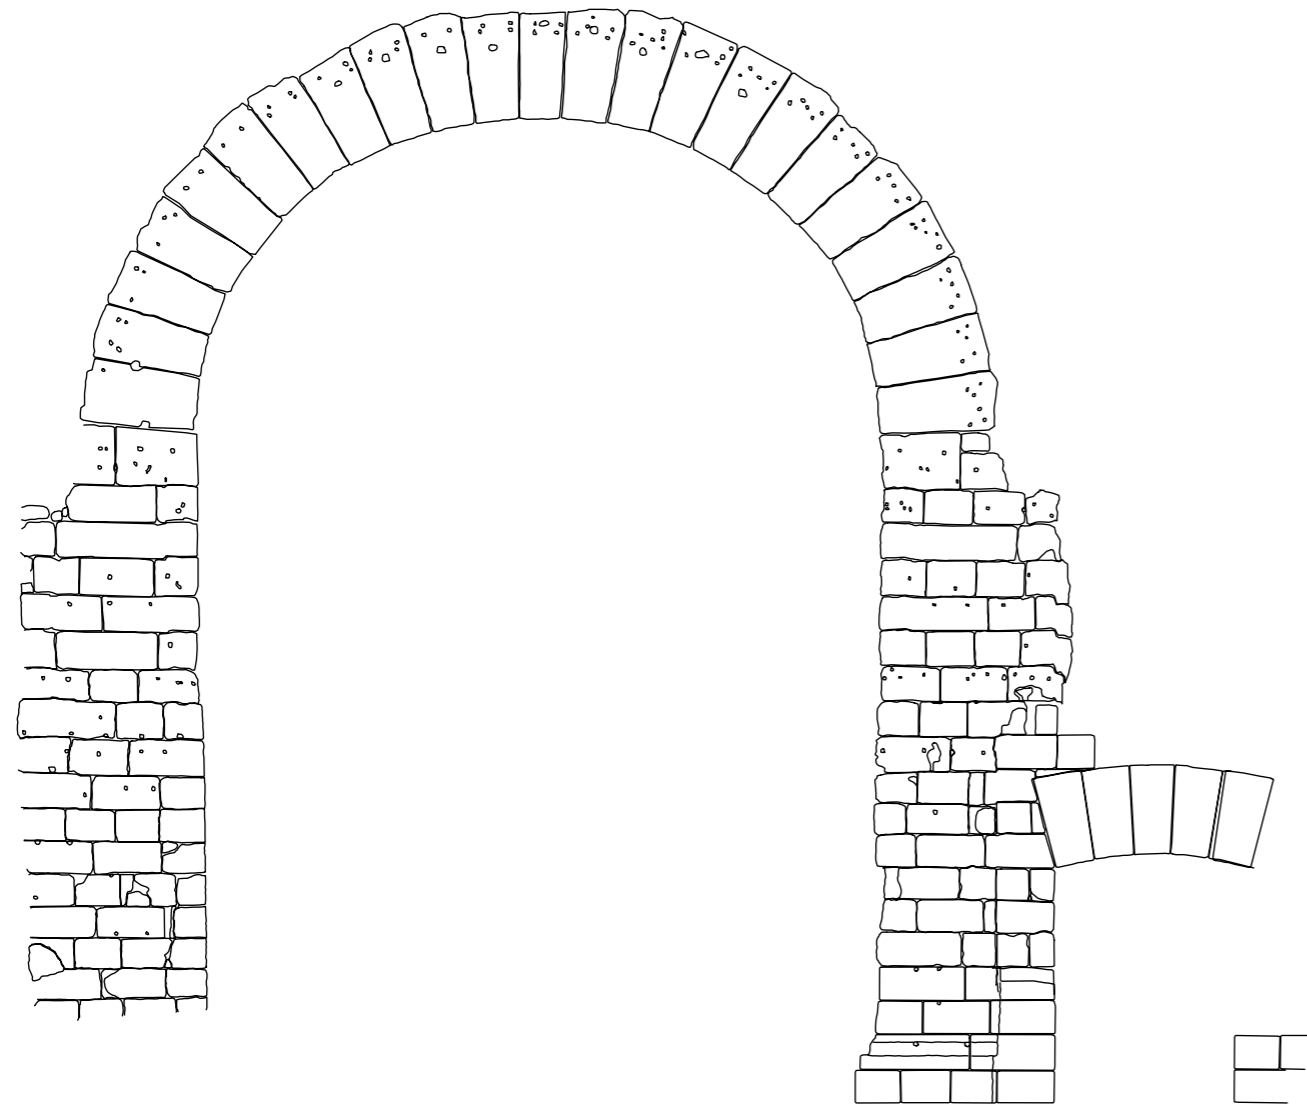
Levantamiento arquitectónico del Arco de Trajano (Lado N). Escala 1:100
